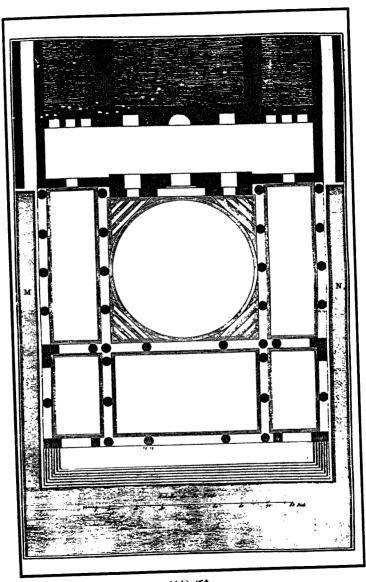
مسجد الناصر مجمد بن قلاوون - مسقط أفقى عن مركز تسجيل الآثار
